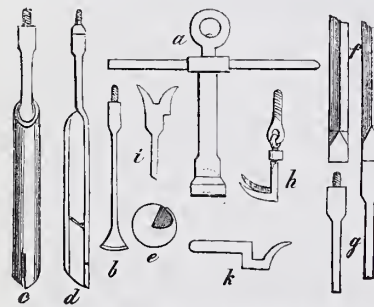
Werkzeuge zum Bohren Artes. Br.
